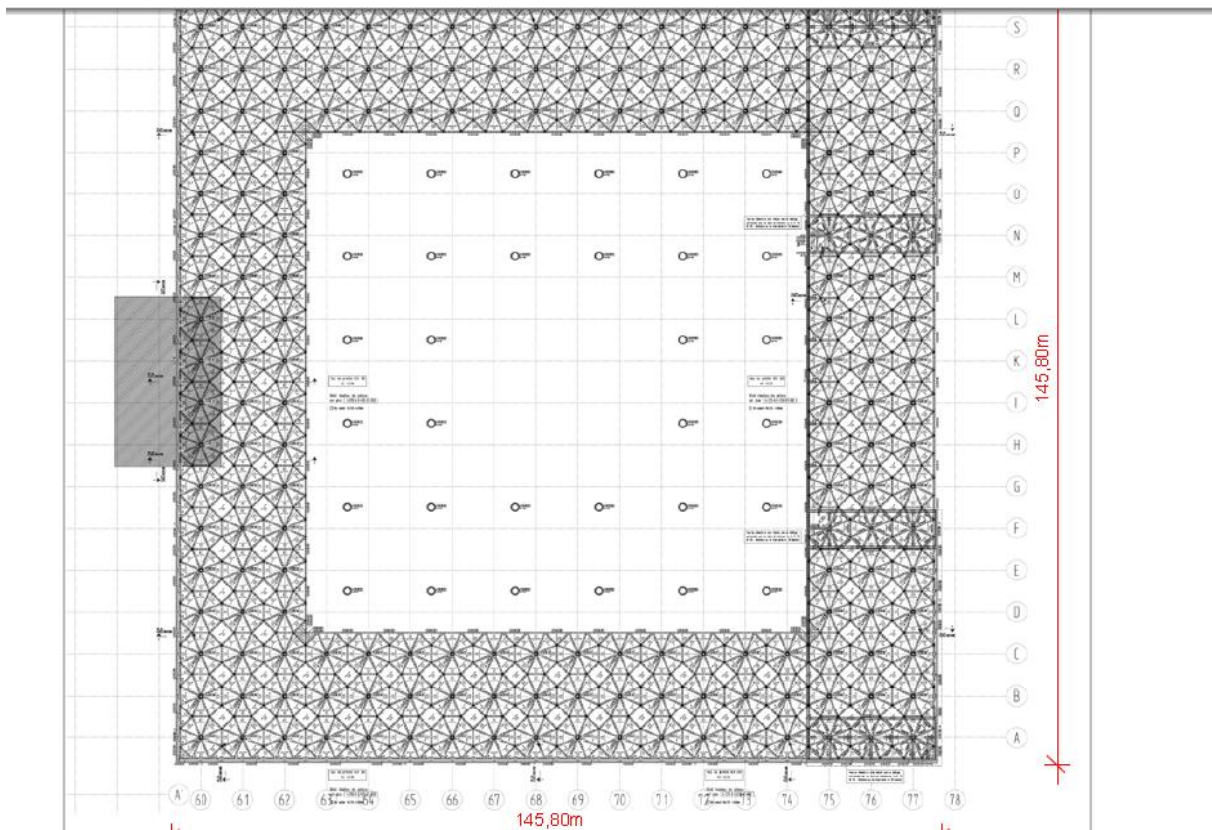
construction métallique du cube extérieur – vue en plan
